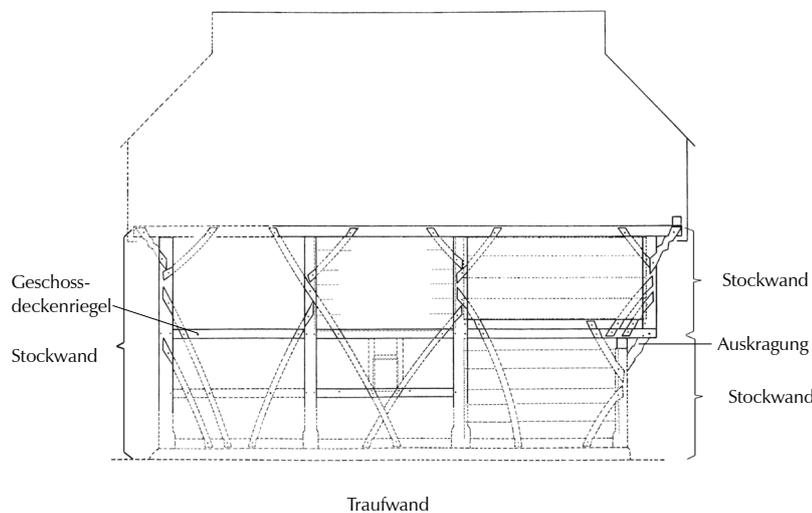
Einstöckiges Traufgerüst bestehend aus Basisstock auf massivem Untergeschoss und Dachstock. Ebringen (Lkr. Breisgau-Hochschwarzwald), Schönbergstr. 42, 1576 (d).
